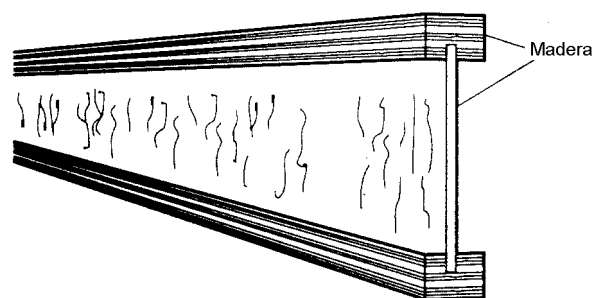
(a)(ii) Construcción típica con viguetas de madera compuestas.
